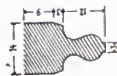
Mlečits. Grundriss der Kirche.
